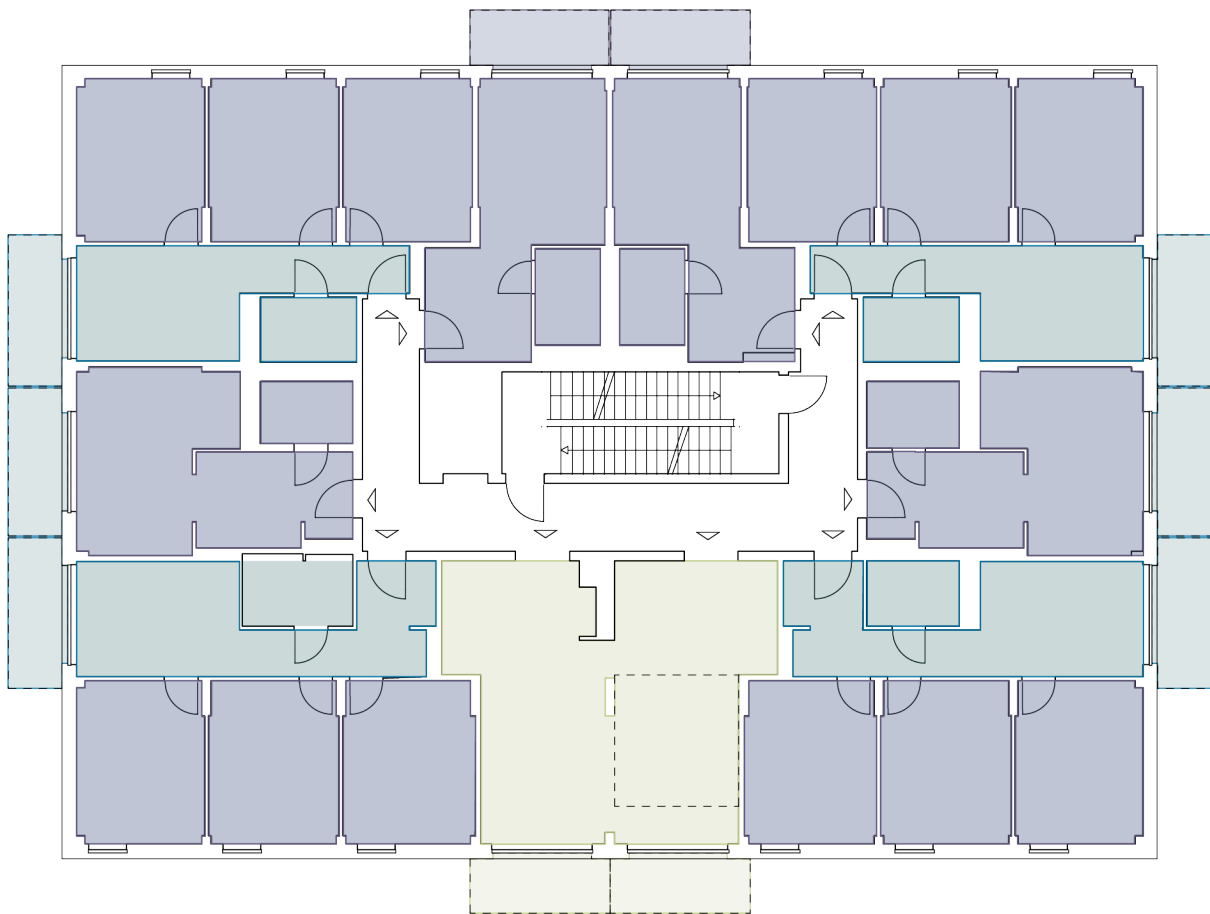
Dezentrale, geschossweise angeordnete, hausgemeinschaftliche Räume. Grundriss Regelgeschoss, Berlin-Marzahn, M 1:200. [©DGJ Architektur GmbH]
